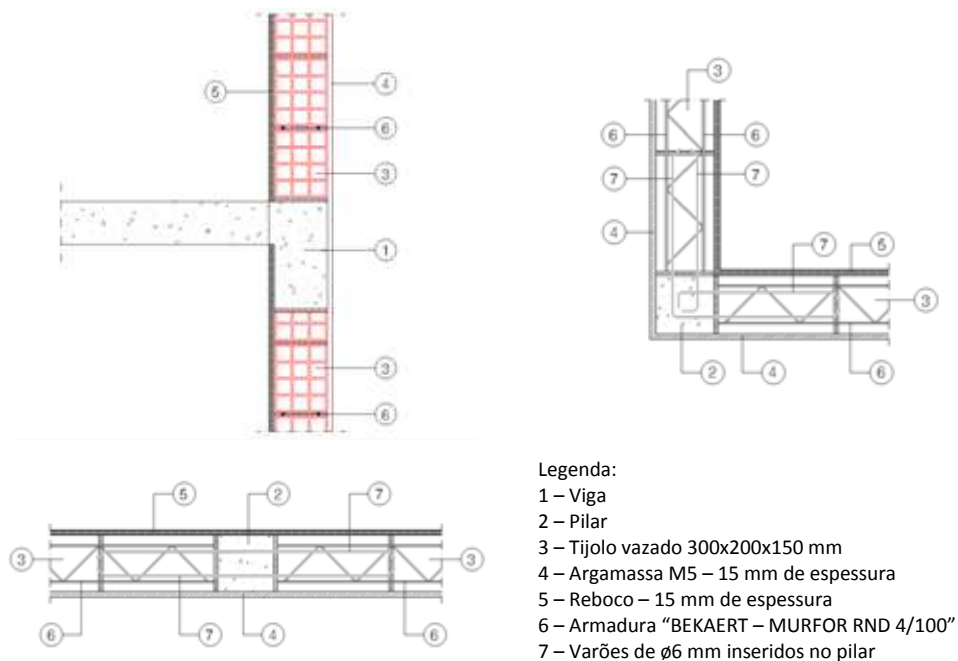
Armadura colocada nas paredes WALL_JAR.
